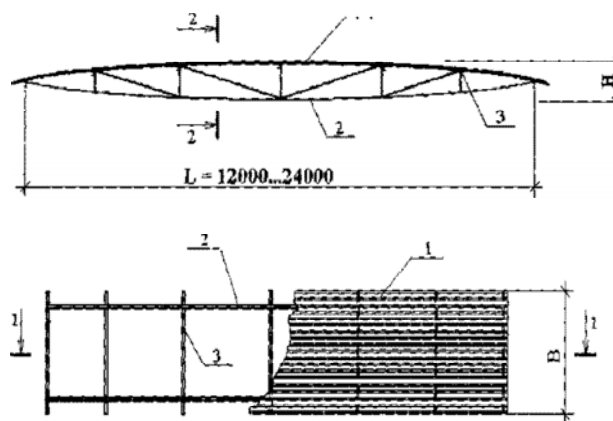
Конструктивная схема решетчатых плит покрытия из профлиста с криволинейной фермой, пролетом до 24 м
